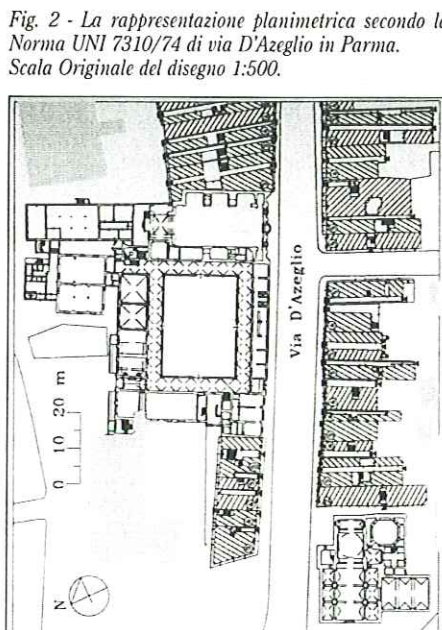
La rappresentazione planimetrica secondo la Norma UNI 7310/74 di via D'Azeglio in Parma.
